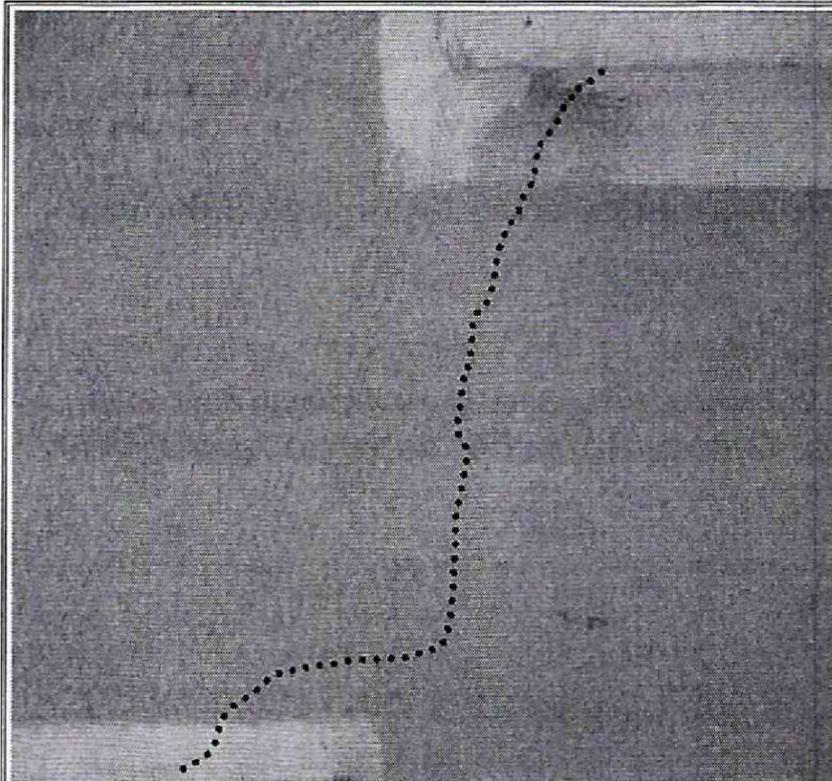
Fisura muro de cerramiento perimetral primer nivel vivienda emplazada en el predio de la Calle 51 D Sur No. 4 – 01 Este
